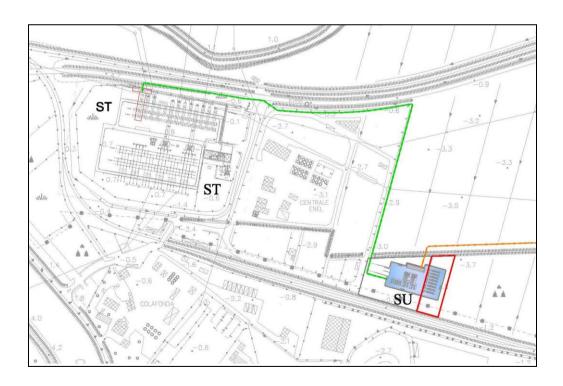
Planimetria delle rete di connessione tra la stazione MT/AT e la stazione AT di TERNA "Adria Sud"
